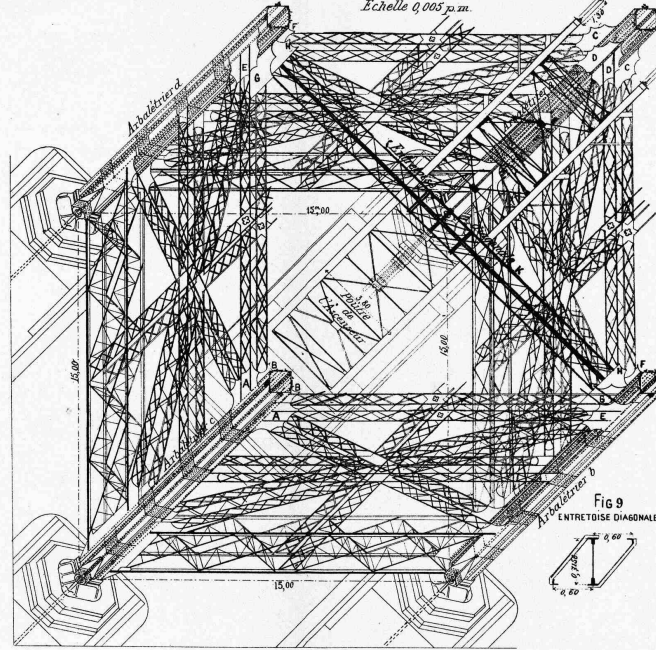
PLAN DE LA PARTIE INFÉRIÈRE B (fig 3)
